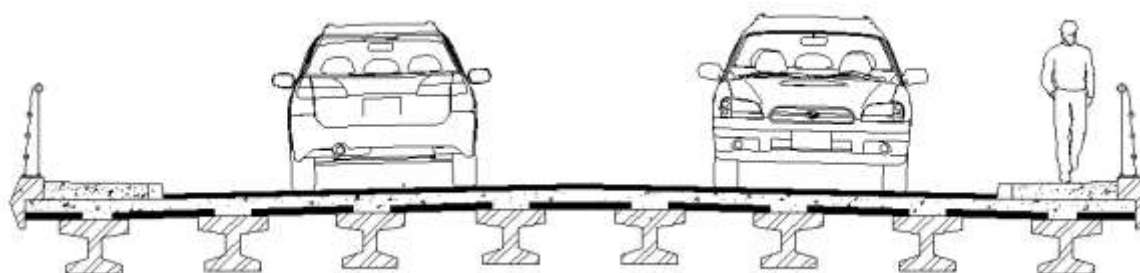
Secção transversal com vigas “I” afastadas do tabuleiro de uma ponte
